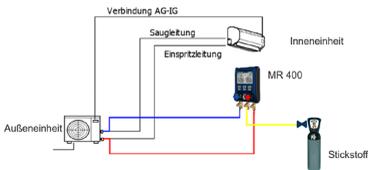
Aansluitvoorbeeld voor drukmeting in een split-systeem
